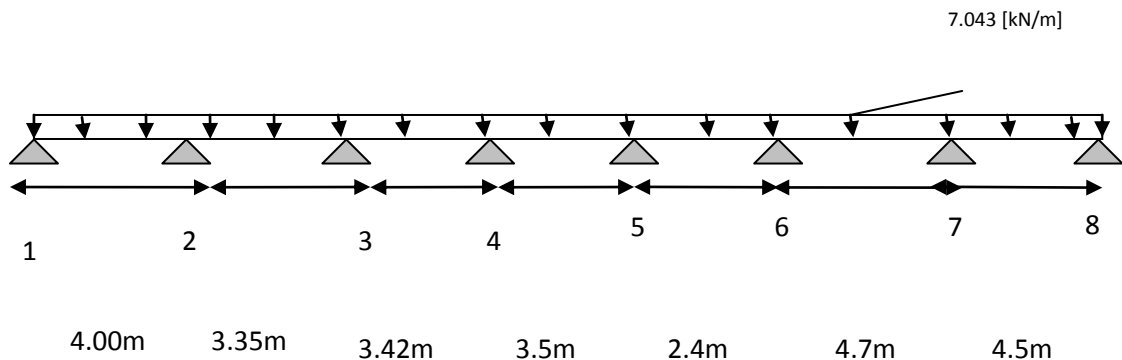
Schéma statique de la poutre continue reposant sur 08 appuis
